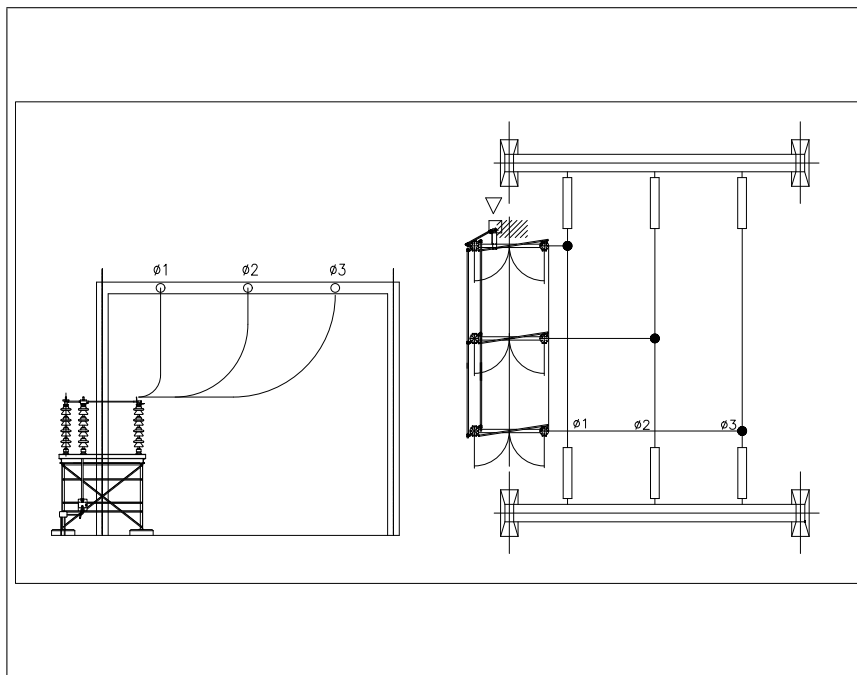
Conexión desconectador horizontal con barra flexible, vista en planta y en corte.
